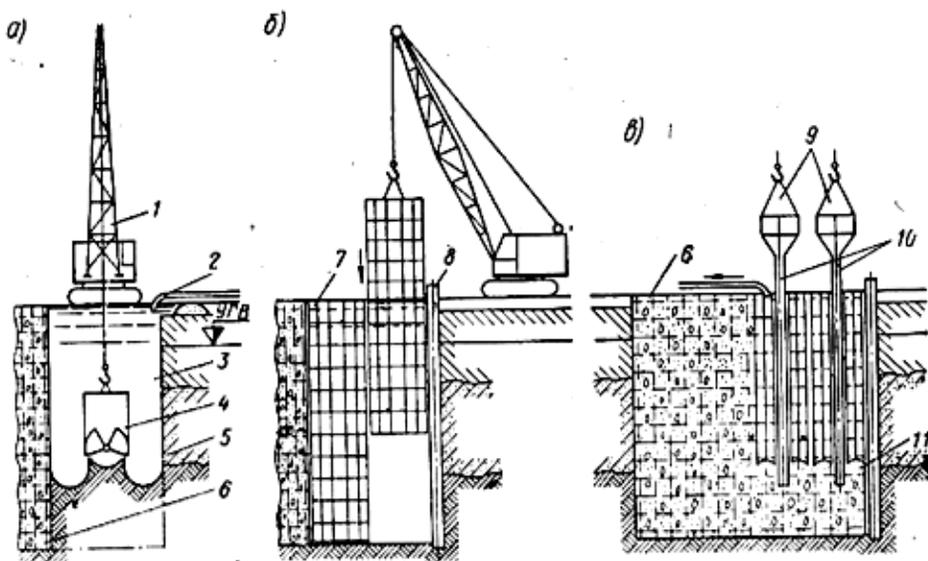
Метод «стена в грунте»: 1 – кран; 2 – трубопровод; 3 – глинистый раствор; 4 – грейфер; 5 – траншея под раствором; 6 – железобетонная стена в грунте; 7 – армокаркас; 8 – труба-перемычка; 9 – бункеры для бетона; 10 – бетонолитные трубы; 11 – бетонная смесь
